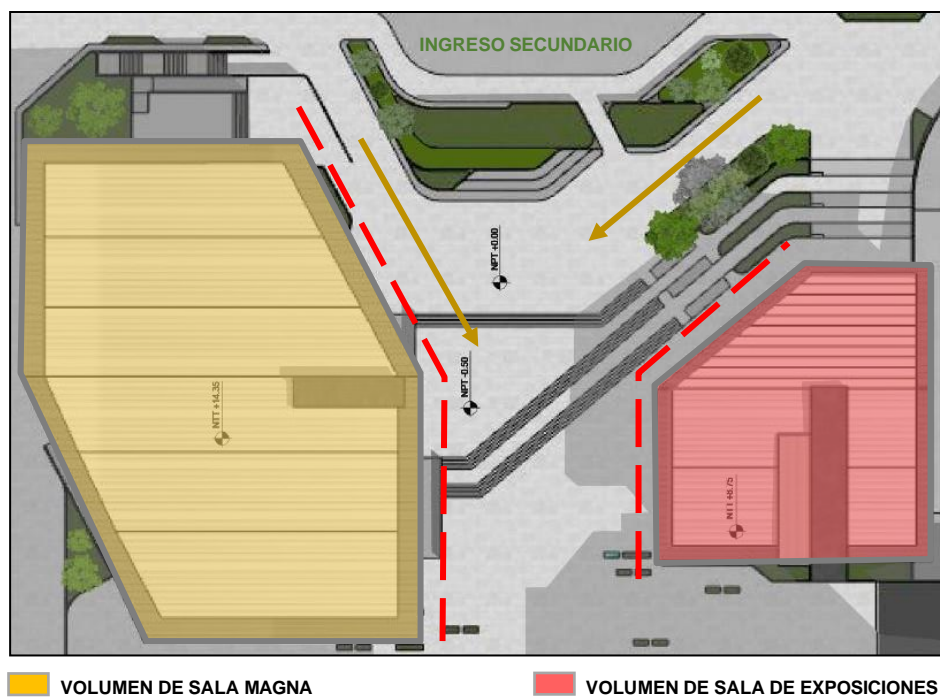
Plot Plan (Recorte ingreso secundario Cineteca Nacional)
